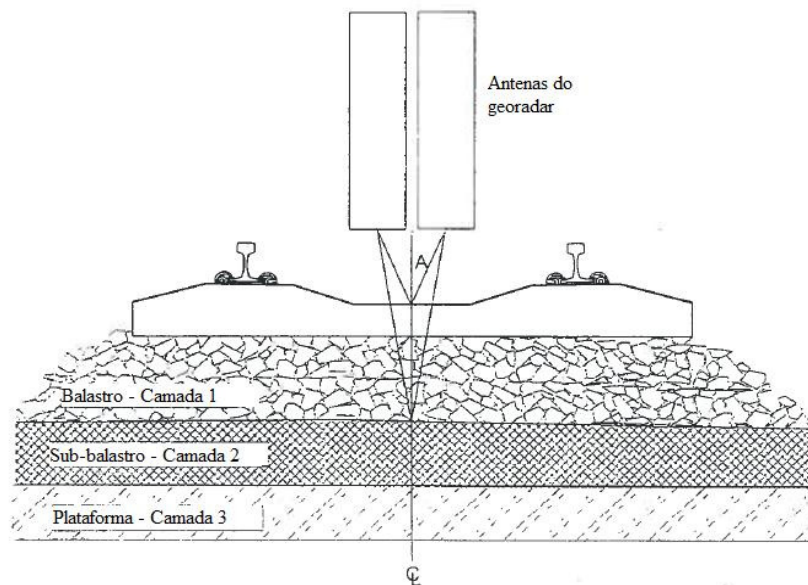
Geometria usual de colocação do georadar na via férrea (adaptado de [1]).
